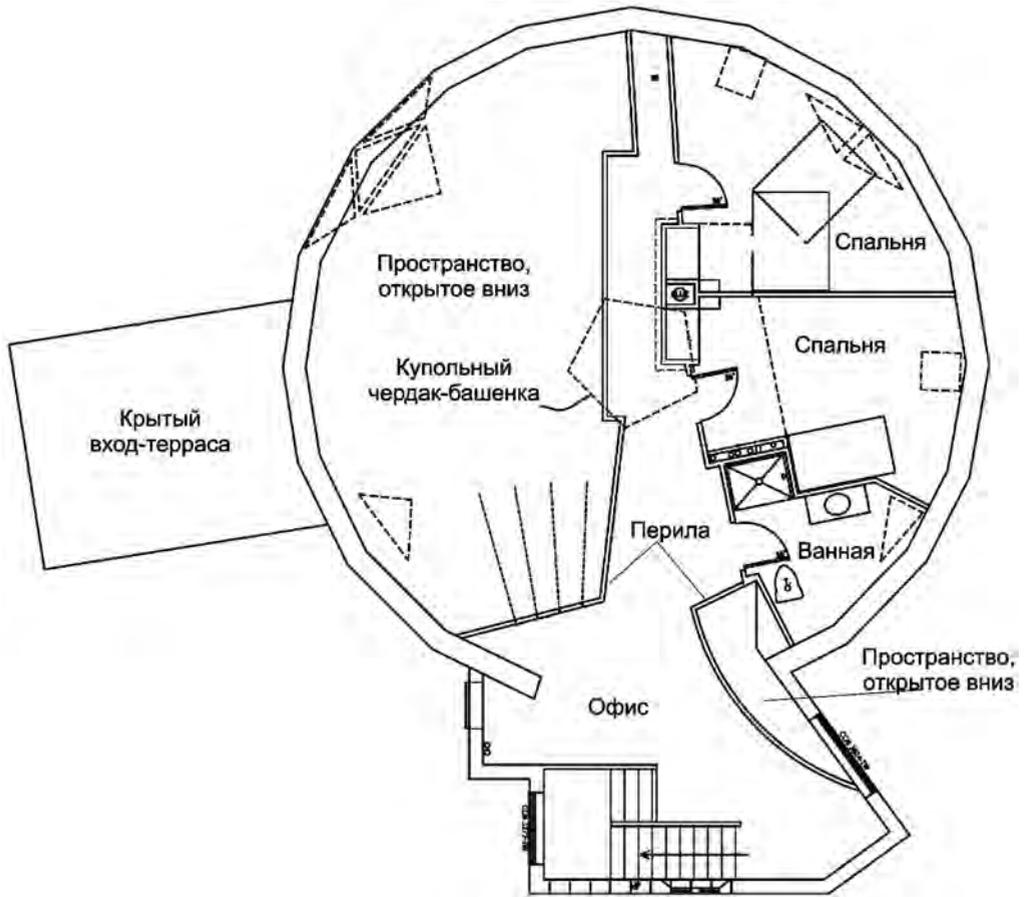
План второго этажа дома-купола The Bear Creek Dome
